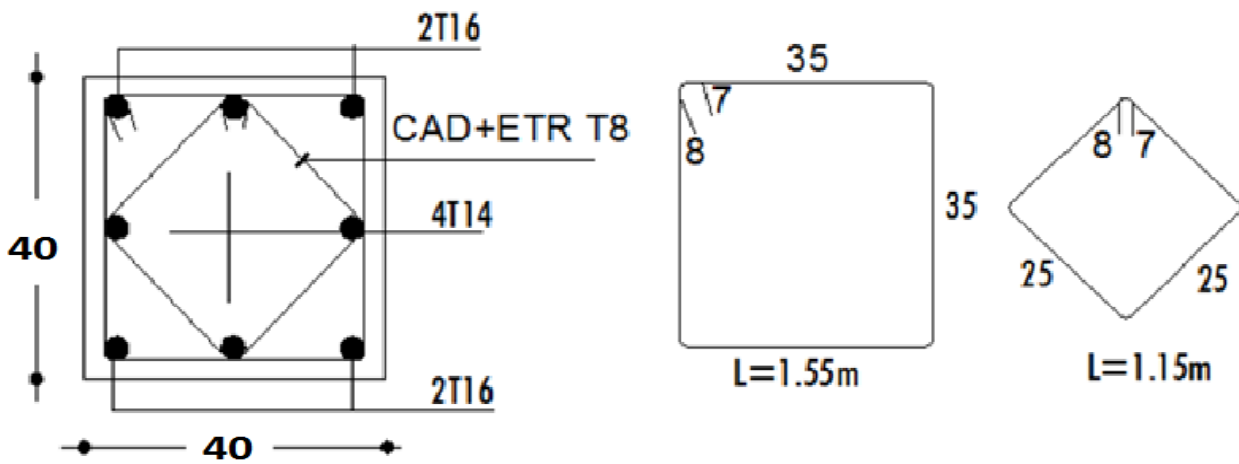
Coupe du ferrailage des poteaux 40x40
